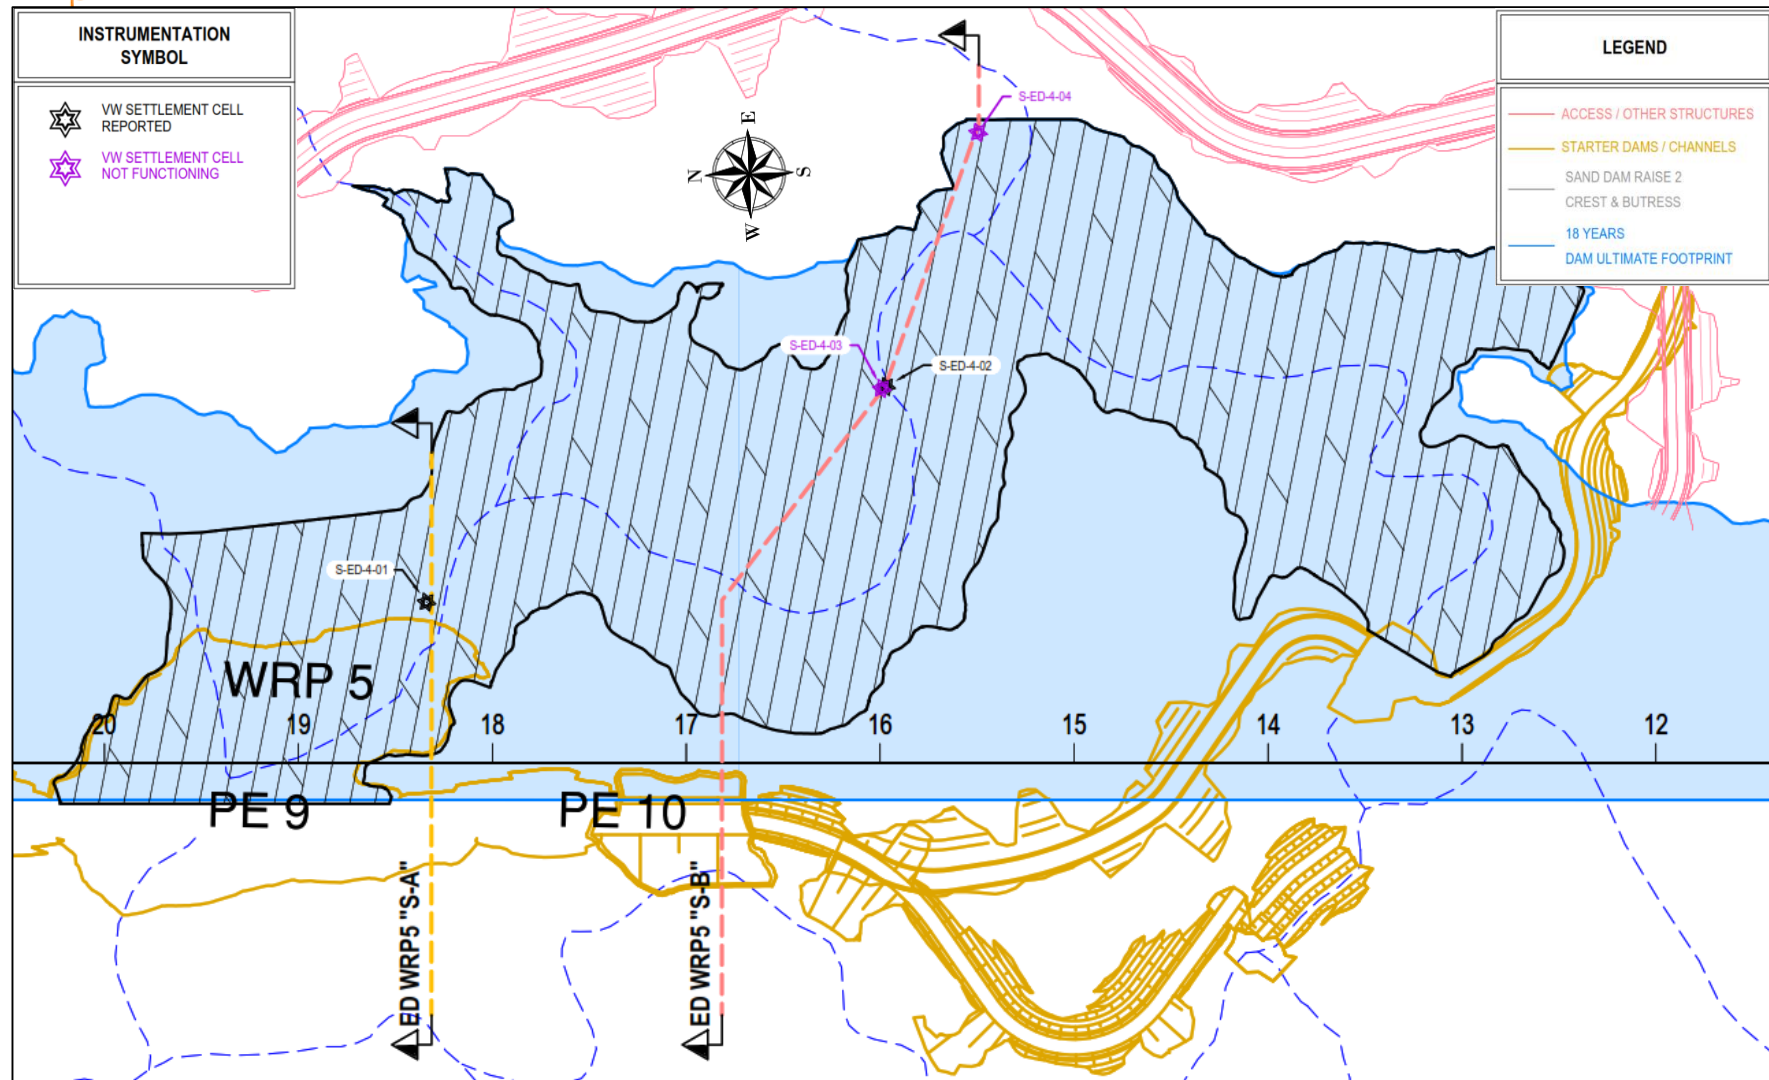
16: Vista en planta del ED WRP5 – Grupos de instrumentos de células de liquidación
